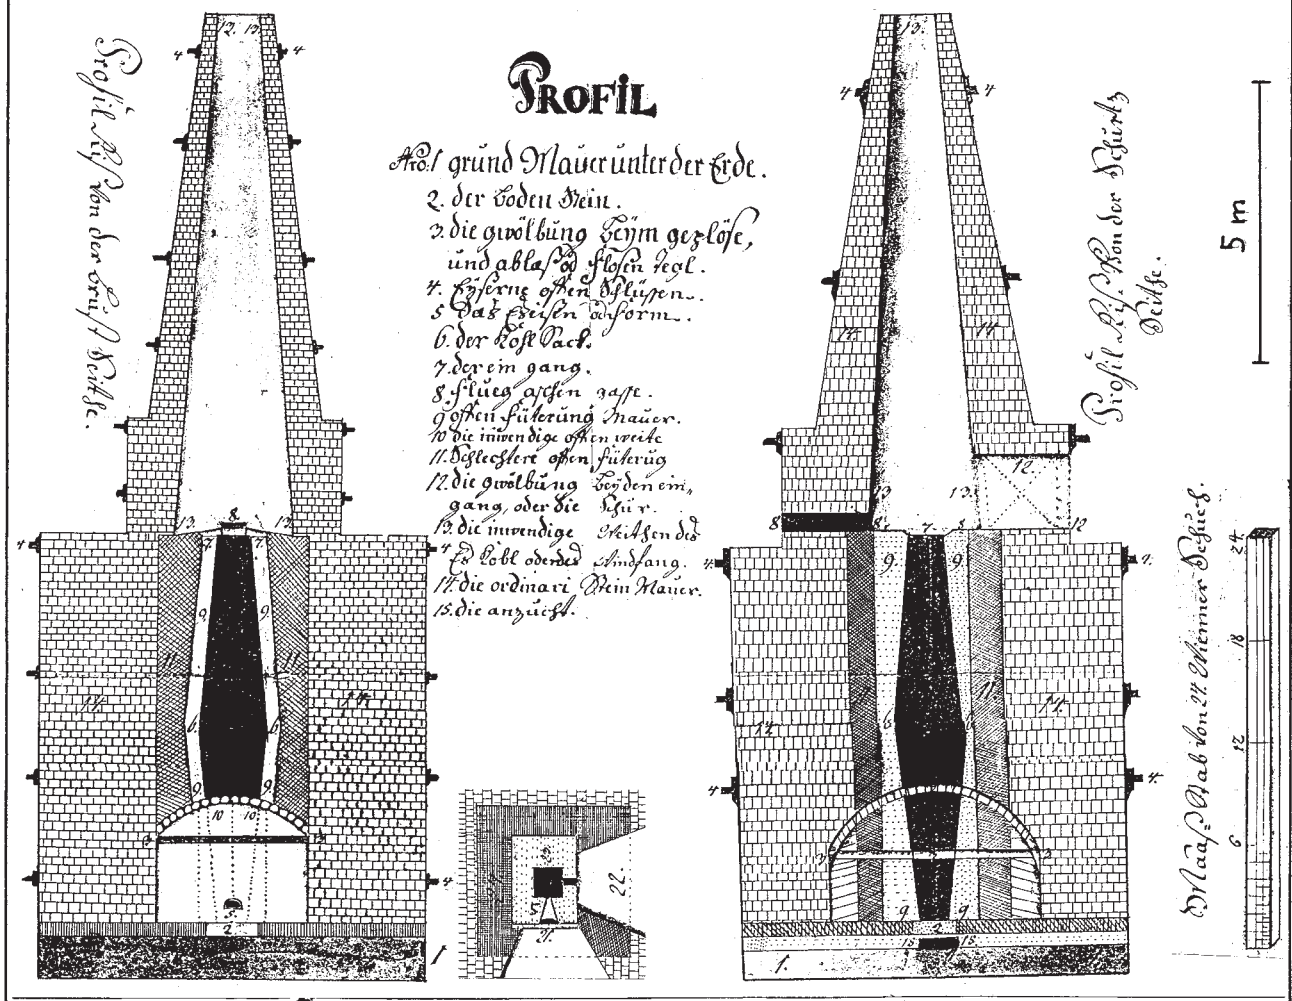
Flossofen („Plaaoffen“) in Turrach, Längsschnitte und Grundriss; um 1750. Plan (Ausschnitt) in den Schwarzenbergischen Archiven Murau.
